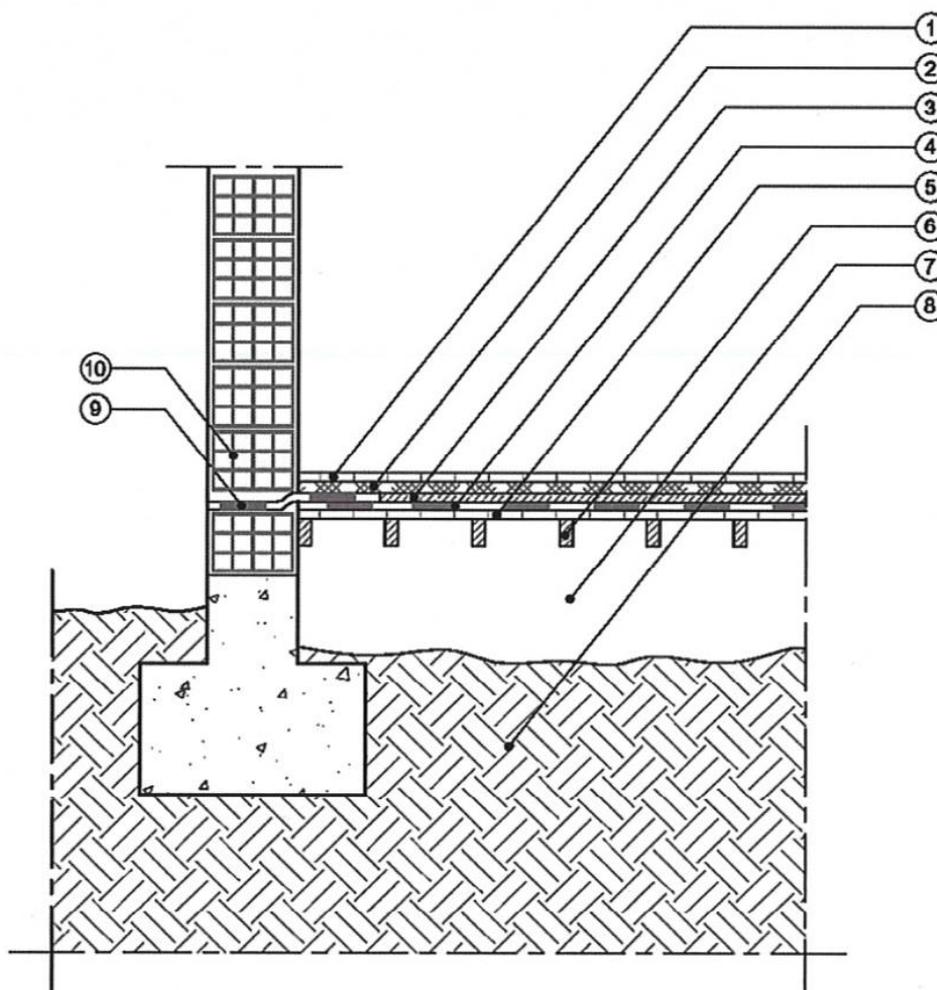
Membrana contra o radão diretamente aplicada sobre o revestimento de piso existente (pavimento com caixa de ar)
